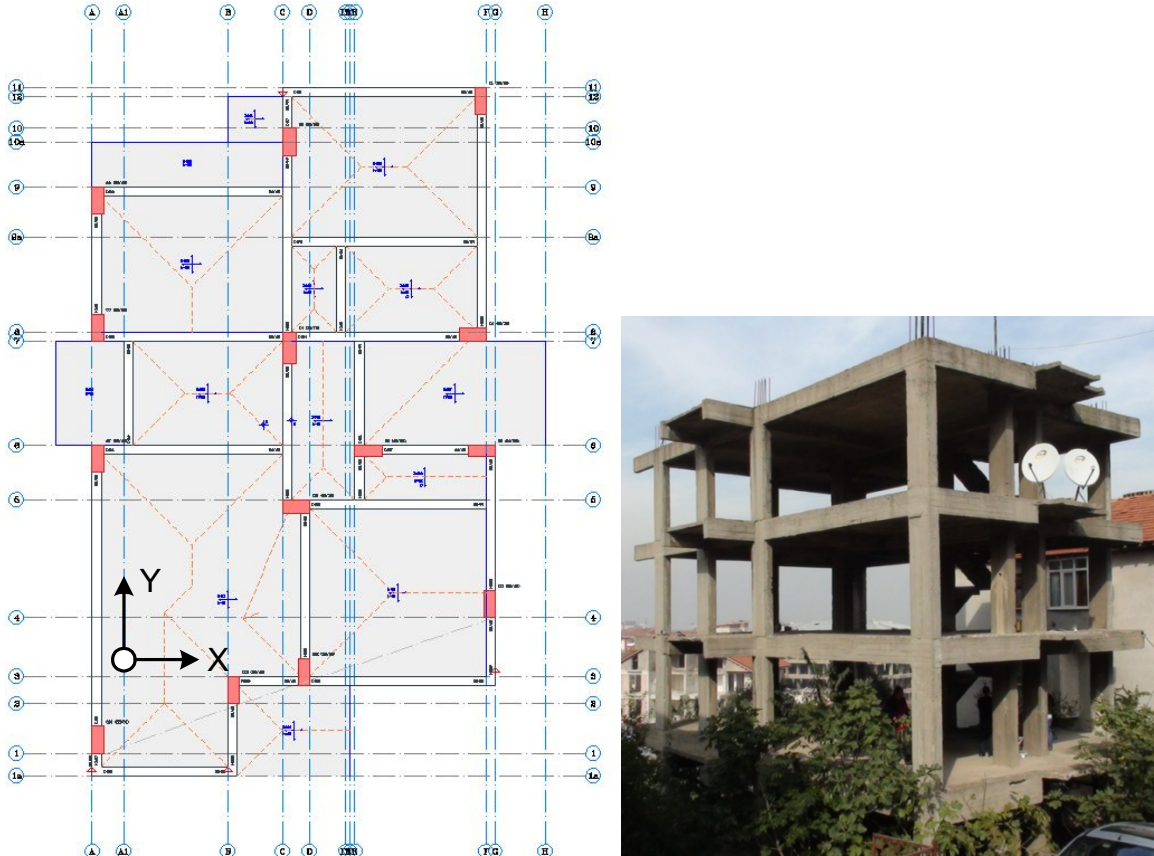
Hisar Apartmanı A Blok kalıp planı ve fotoğrafı
